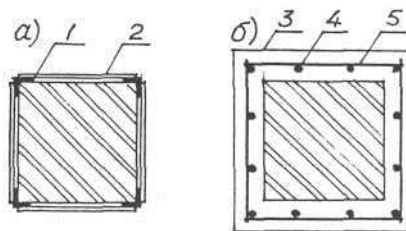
(1 — вертикальные уголки, 2 — планки, 3 — монолитный бетон, 4 — продольная арматура, 5 — хомуты)
